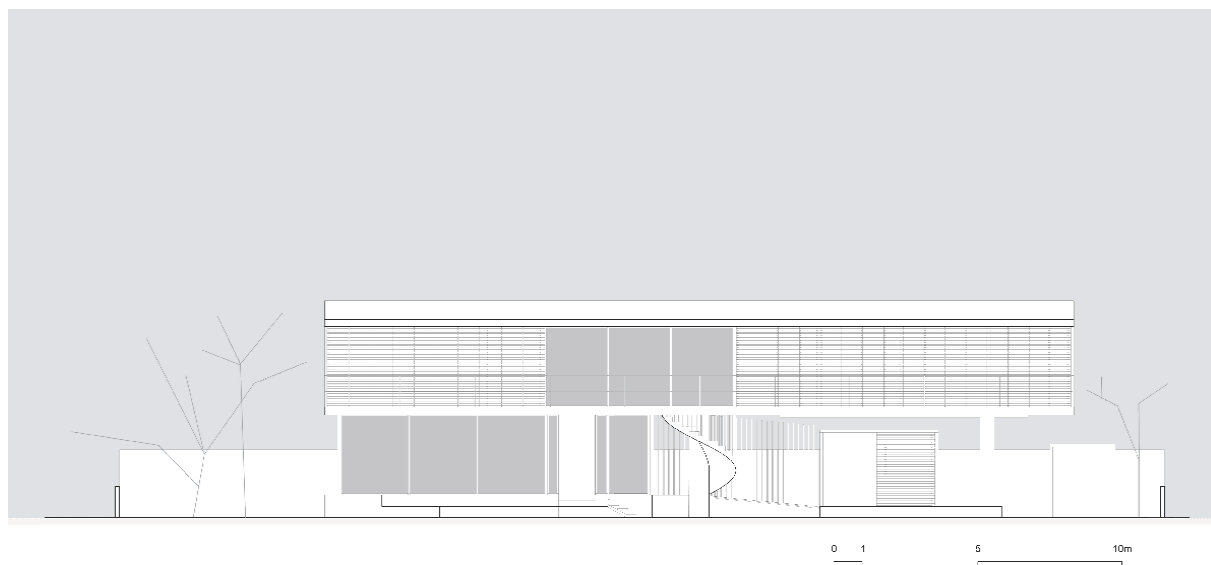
Elevação sul (vista frontal). Fonte: AUTOR (2017).
